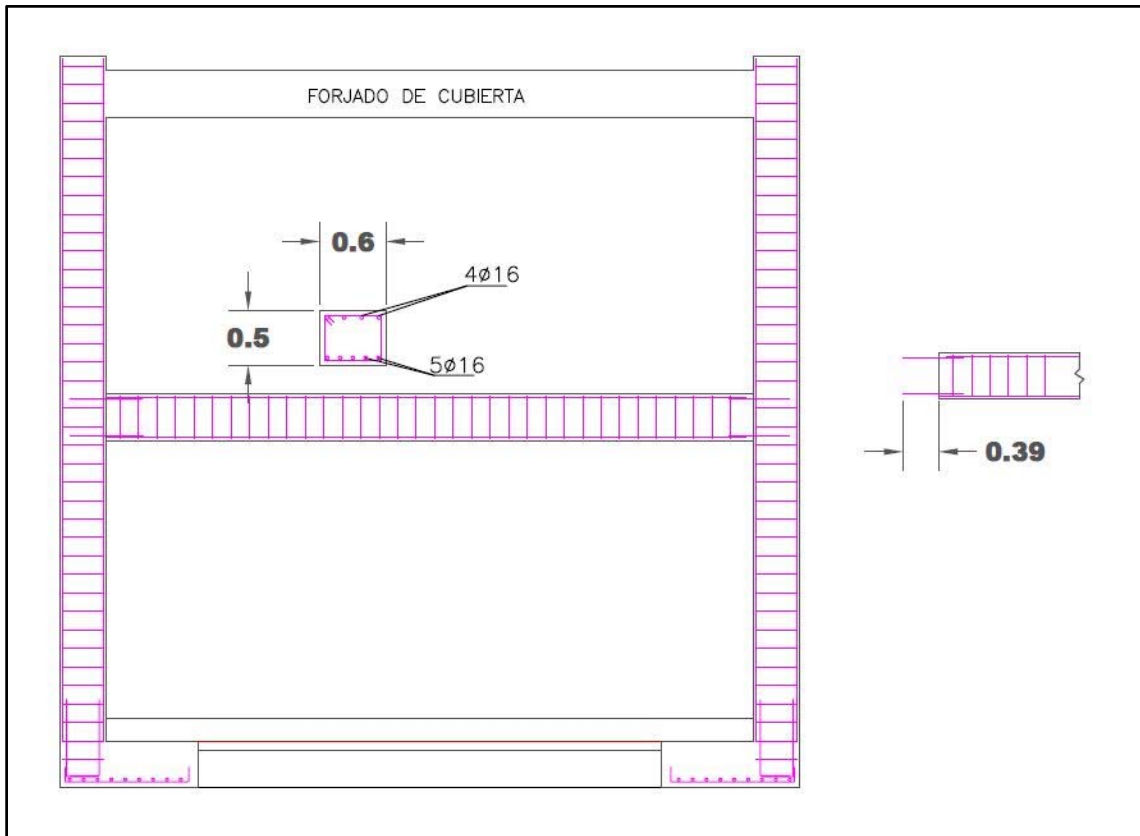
Sección tipo del armado y de la viga a colocar.
